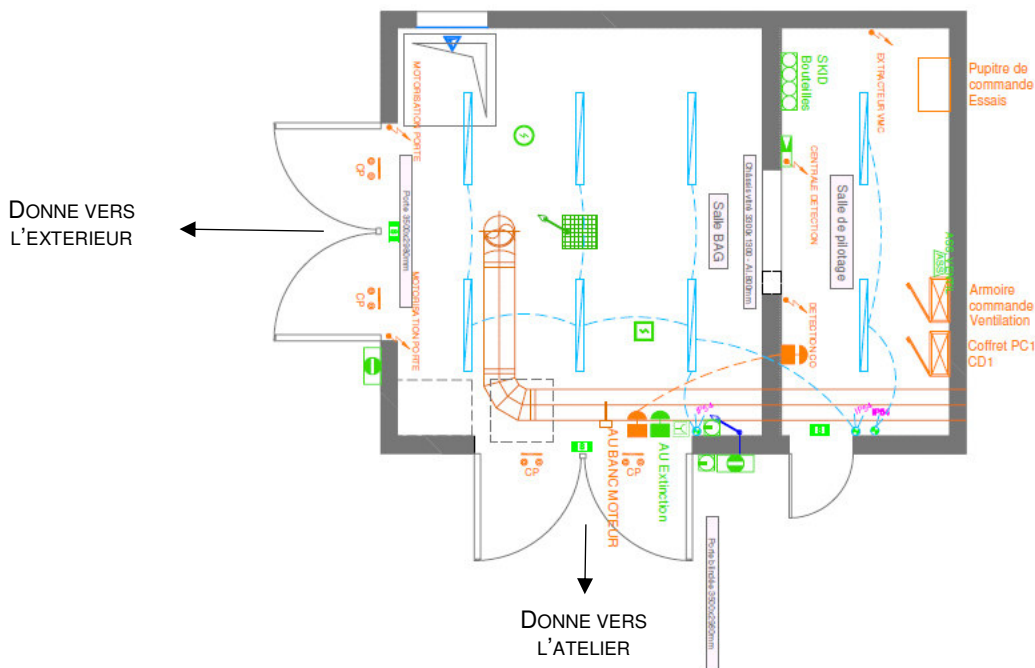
PLAN SCHEMATIQUE DE LA SALLE BAG (ECHELLE NON CONTRACTUELLE).
